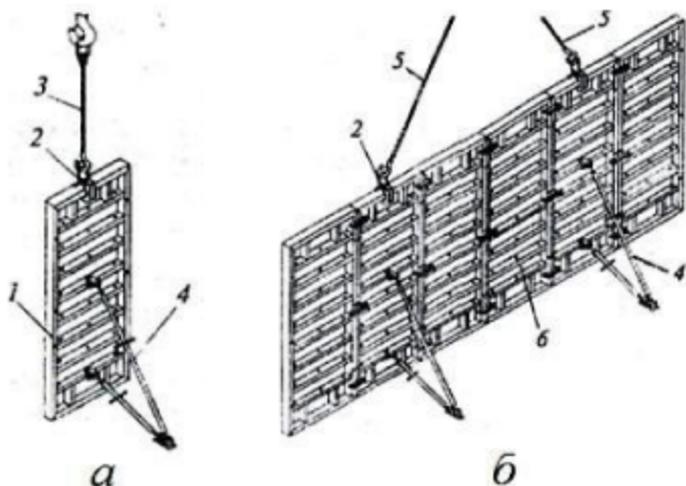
Подъем, установка и раскрепление опалубки стен:
